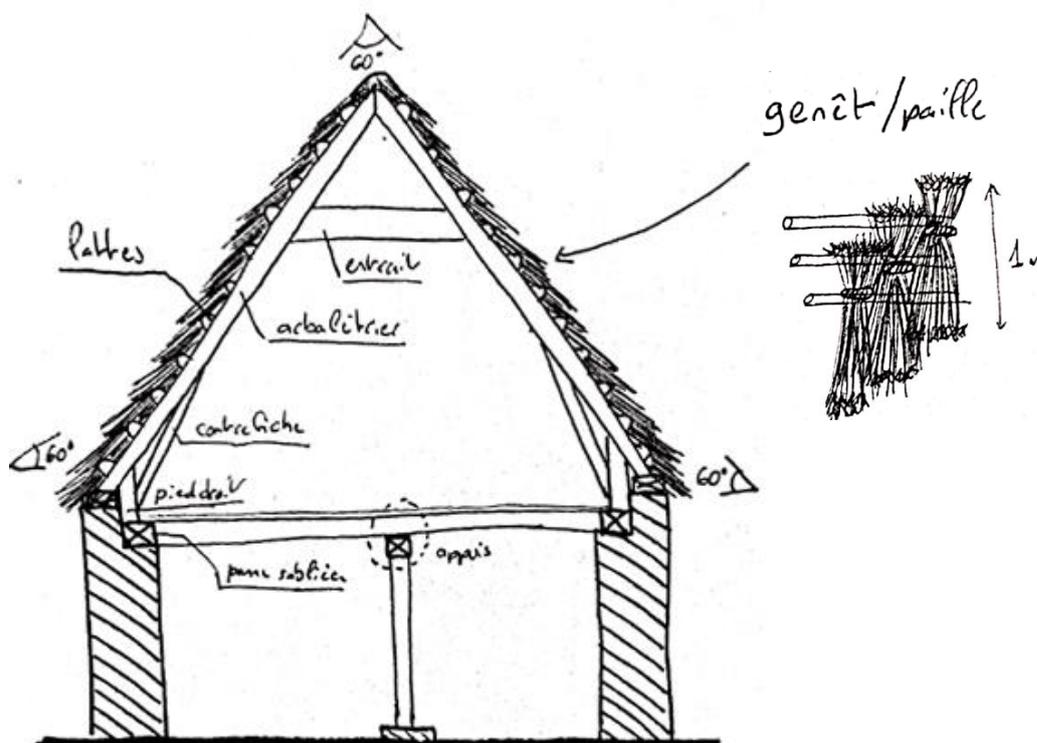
Schéma constructif d'une couverture en genêt ou en paille
